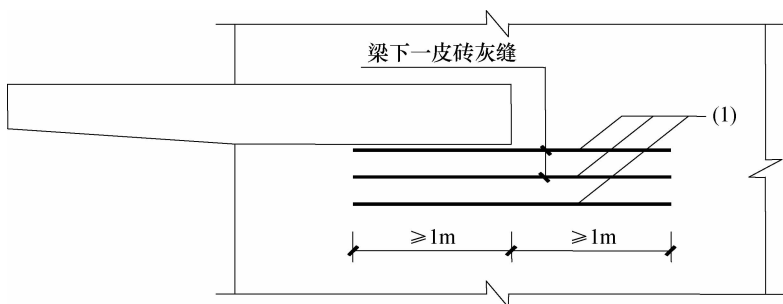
顶层挑梁抹端钢筋网片或钢筋
